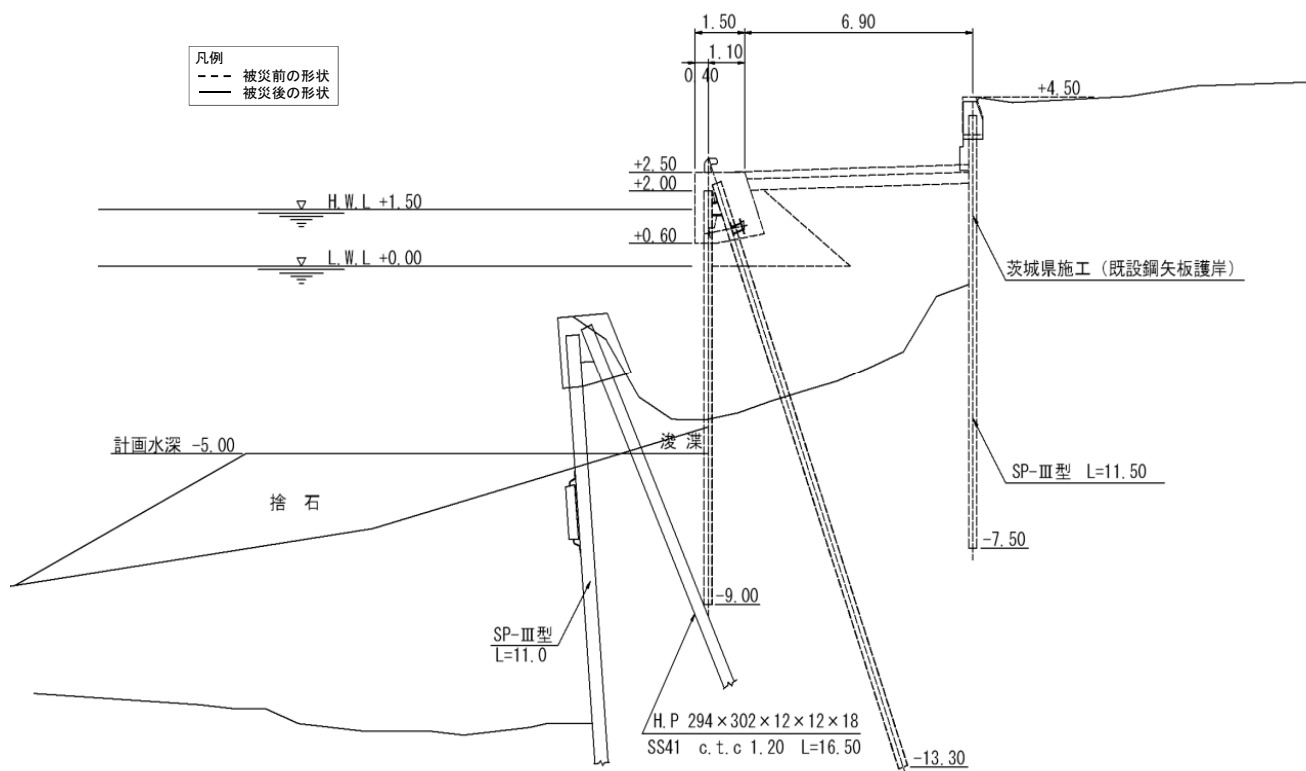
No.5 池向岸壁の断面図（被災後）
